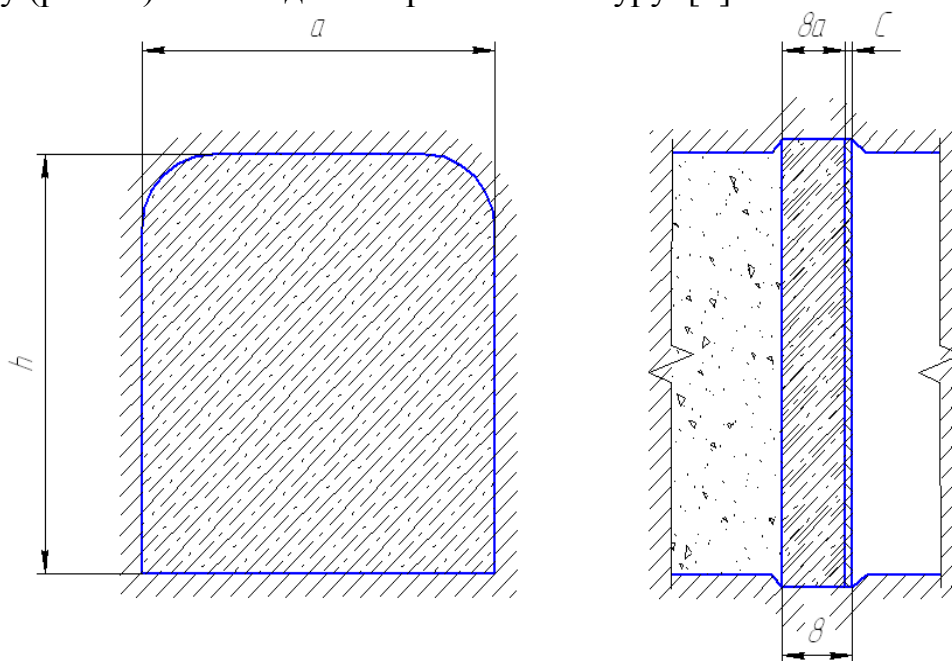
Конструкция железобетонной изолирующей перемычки, защемленной по контуру
